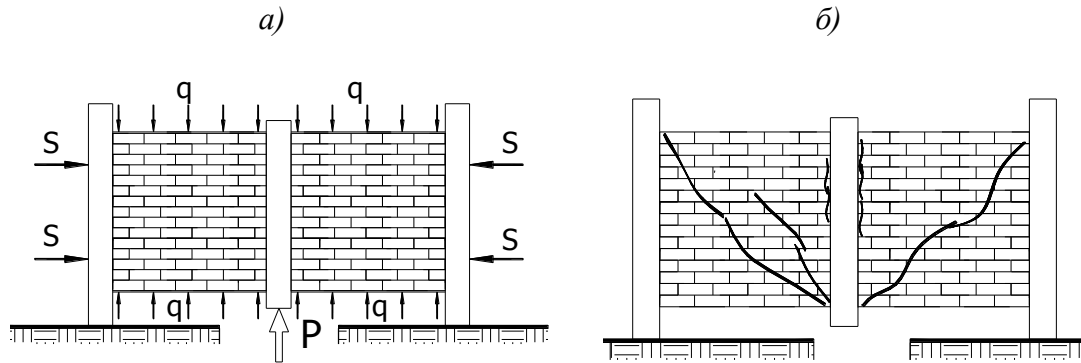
Испытания кирпичной кладки на срез по перевязанному сечению:
